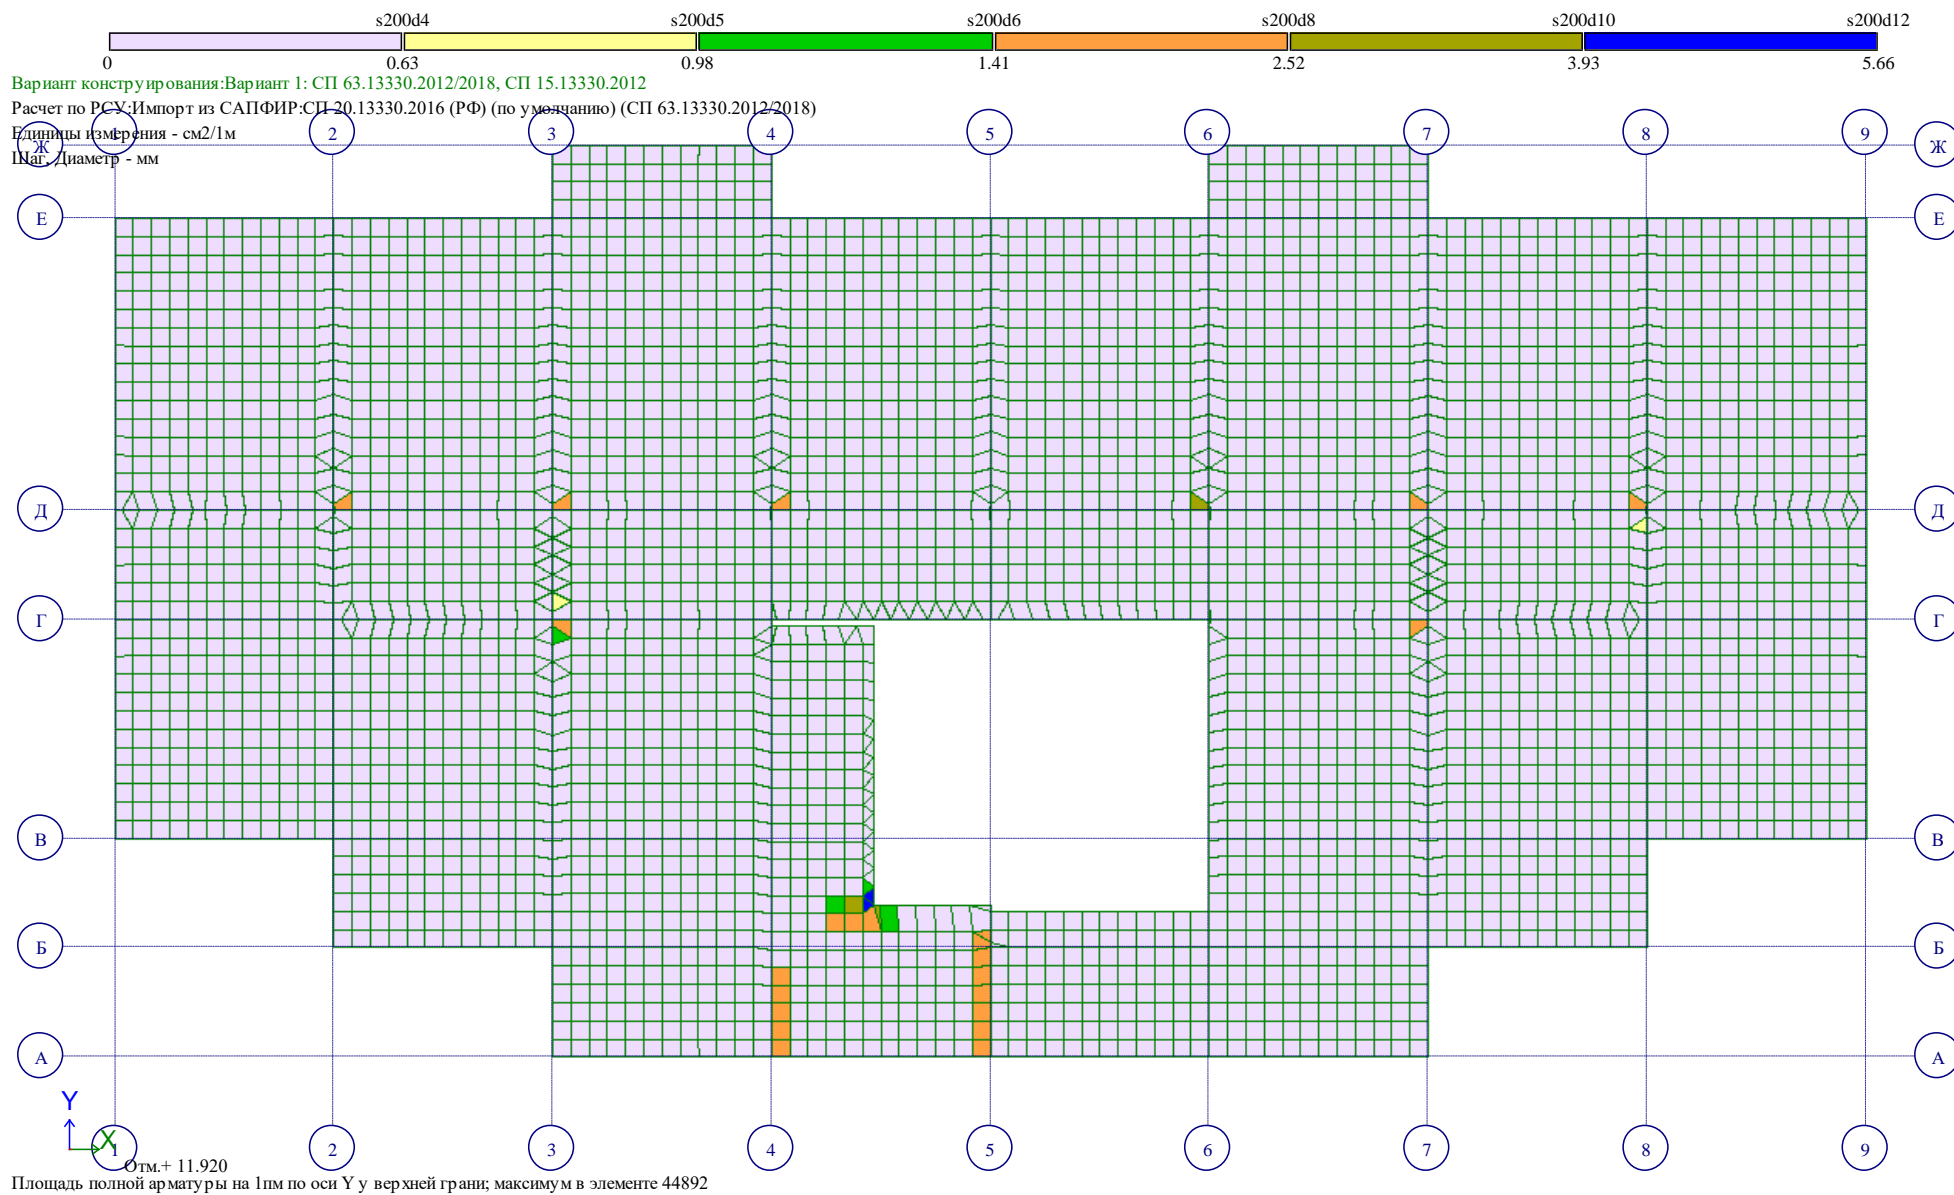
Площадь полной арматуры на 1мм по оси Y у верхней грани
